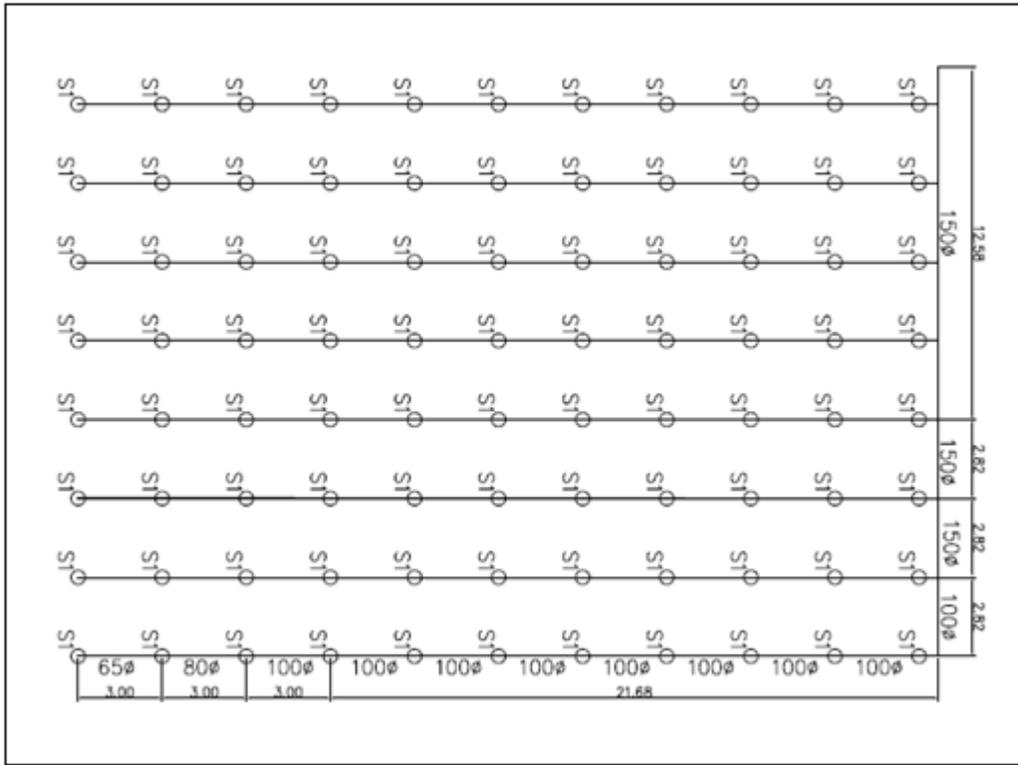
Sistema de supresión para la zona del pulmón. Sistema con tubería seca con válvula de pre acción
